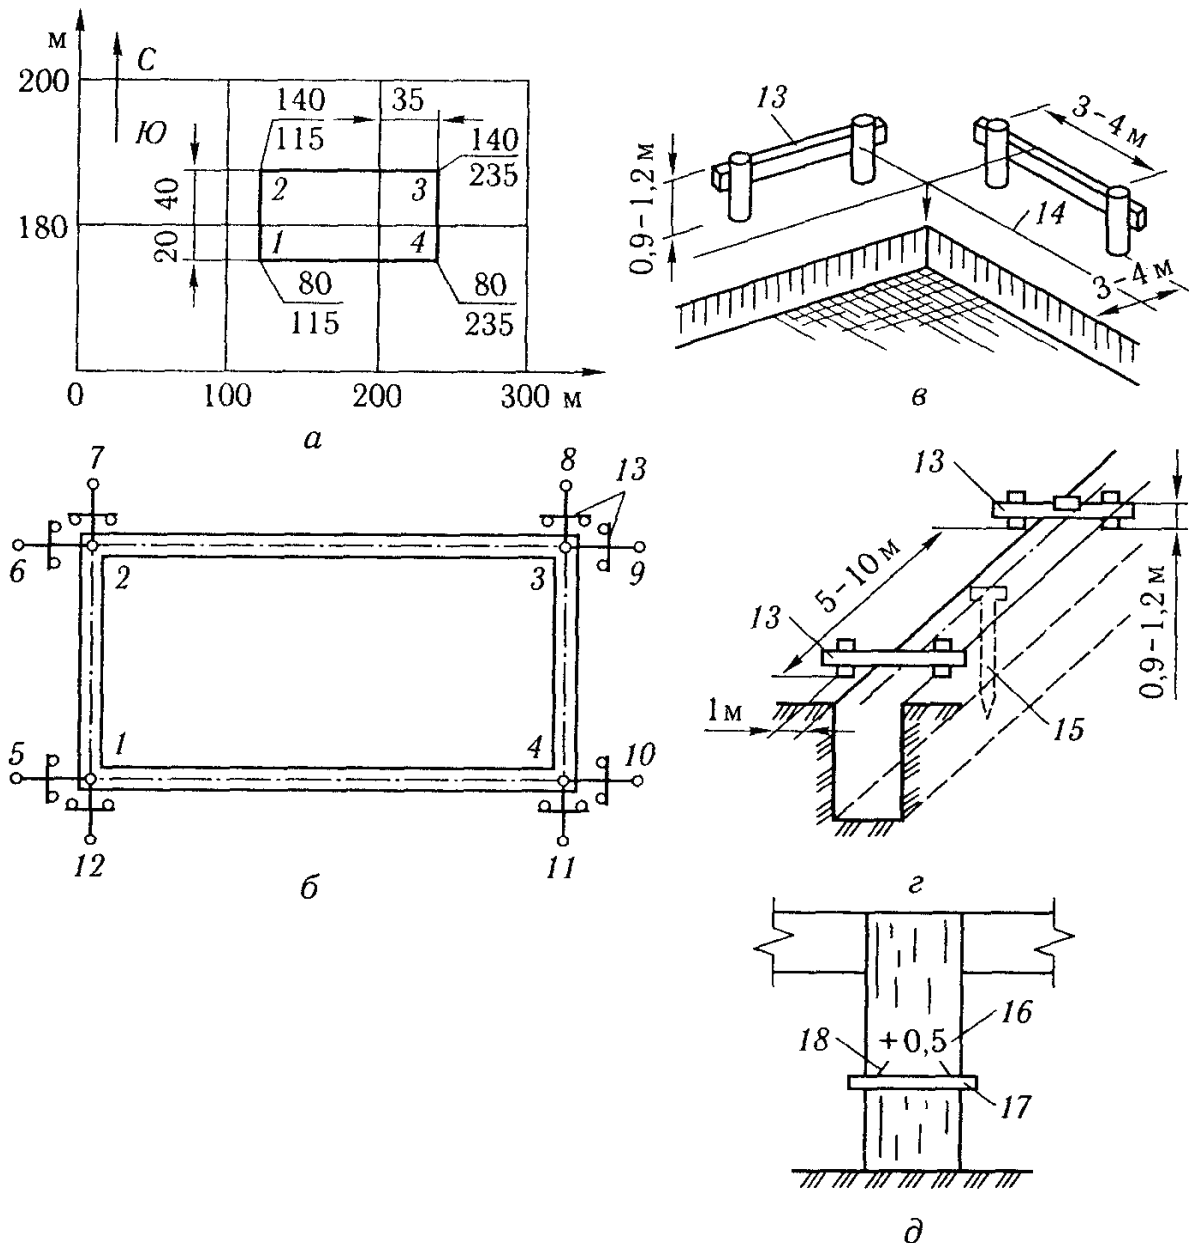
Розбивка котлованів і траншей: а – прив'язування будівлі до геодезичної будівельної сітки; б – закріплення осей будівлі на місцевості; в – розбивання котловану із застосуванням огорожі; г – те саме, траншей; д – тимчасовий репер на стовпчику огорожі; 1 – 4 – положення точок на кутах будівлі; 5 – 12 – виноска для закріплення осей; 13 – огорожа; 14 – дрiт; 15 – візирка; 16 – стовп огорожі; 17 – врізана планка; 18 – умовна (уявна) позначка й позначка від рівня підлоги
